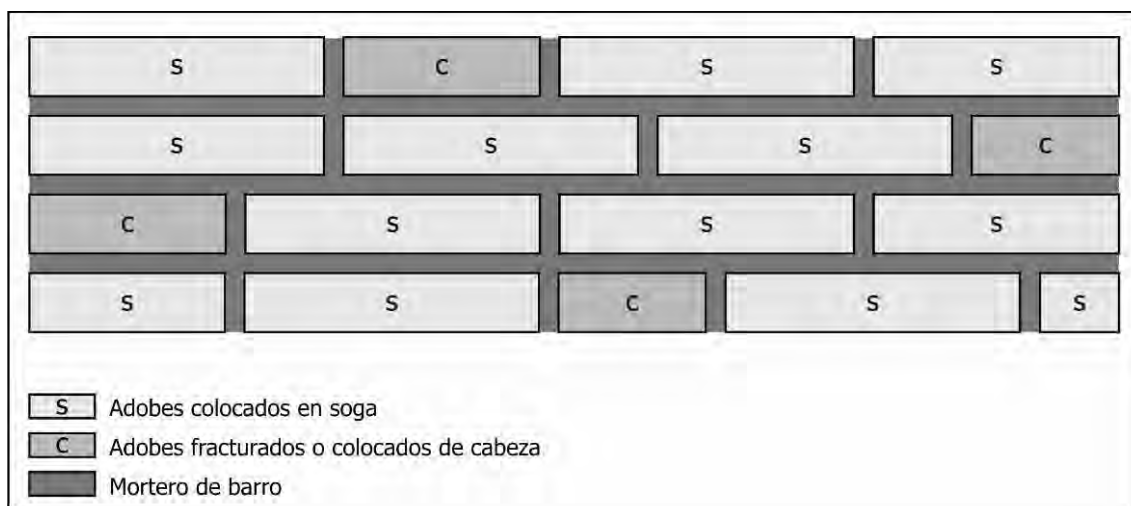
Esquema del aparejo irregular de mampostería en adobe de R3.
